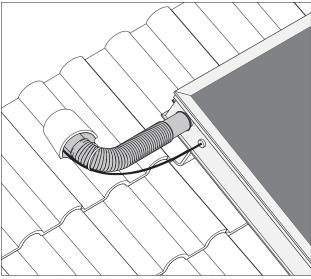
Kabel des Kollektorfühlers mit Kabelbinder am Anschlussschlauch befestigen.
